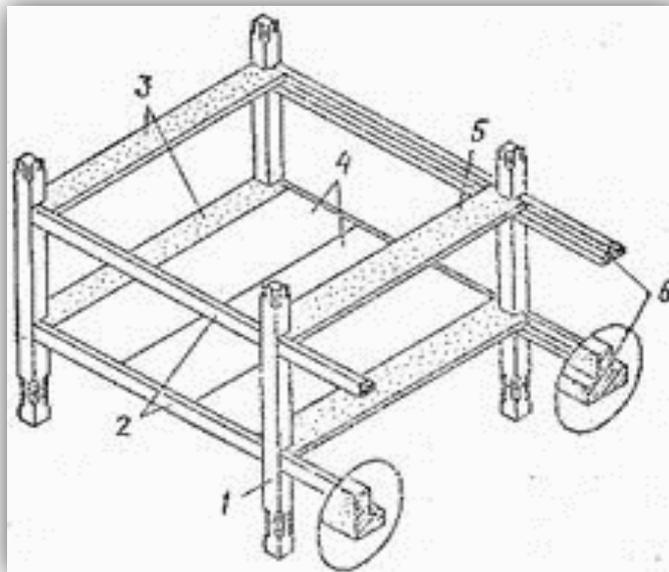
Конструктивные элементы сборного железобетонного каркаса гражданского здания
